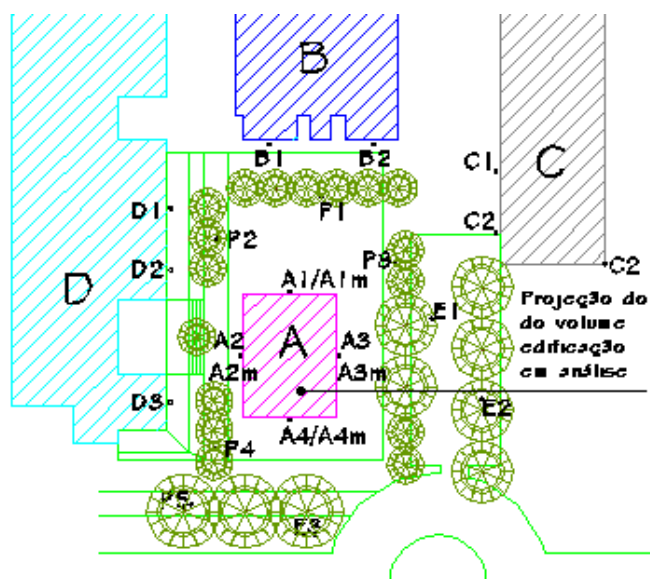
Planta baixa do modelo com a localização dos pontos de análise
